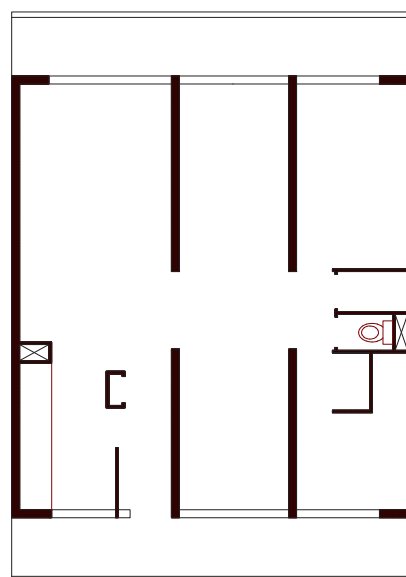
Planta tipo B - DeFlat Kleiburg - NL Architects
